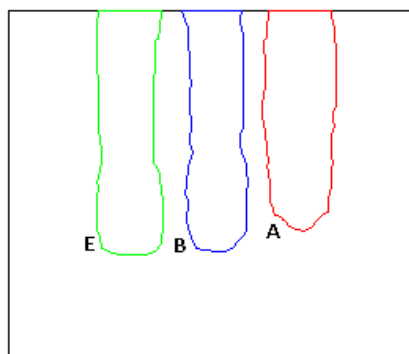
Comparação da geometria final dos três tipos de coluna estudados (E- encamisada; B- pilão tipo B; A- pilão tipo A)
